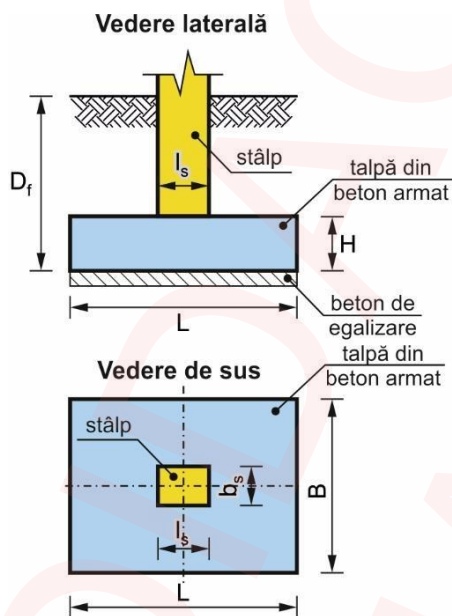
Fundație flexibilă de tip dală din beton armat de formă prismatică
